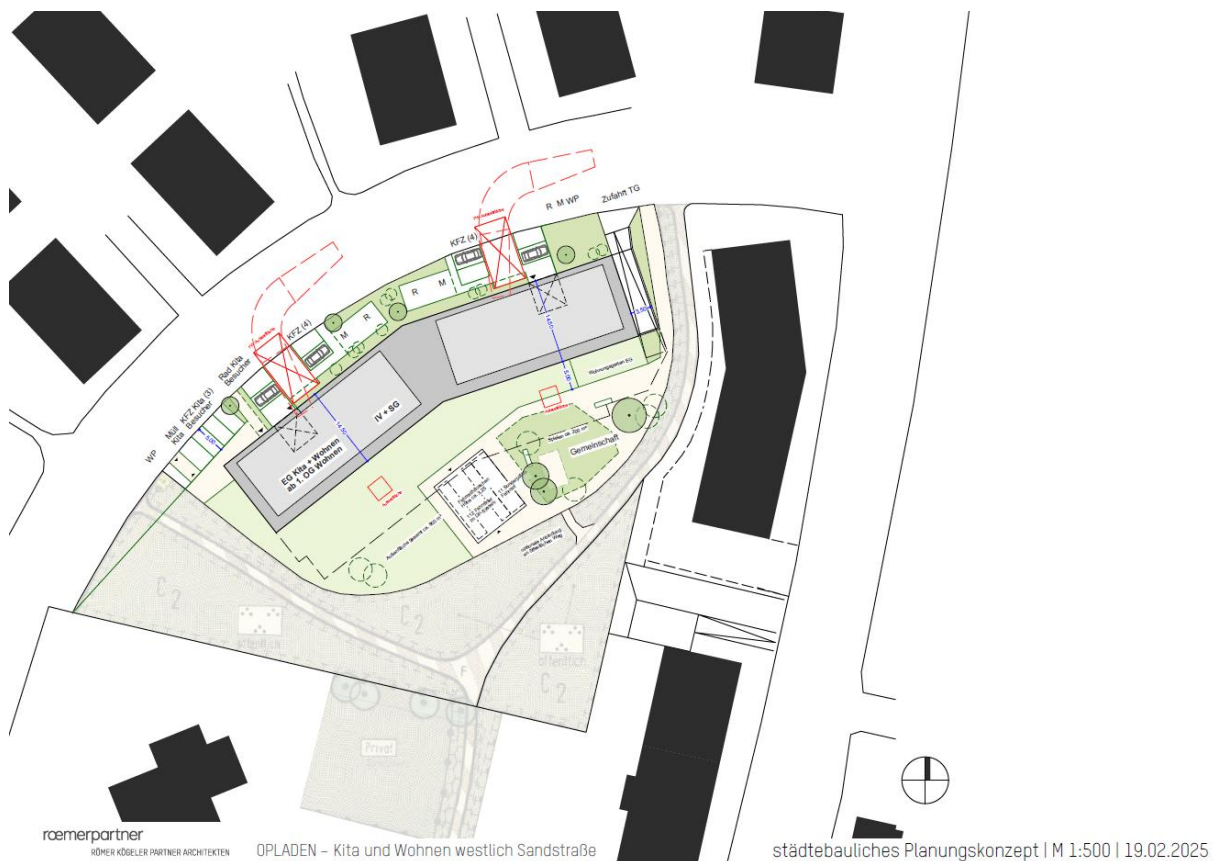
Städtebauliches Planungskonzept der geplanten Bebauung.
